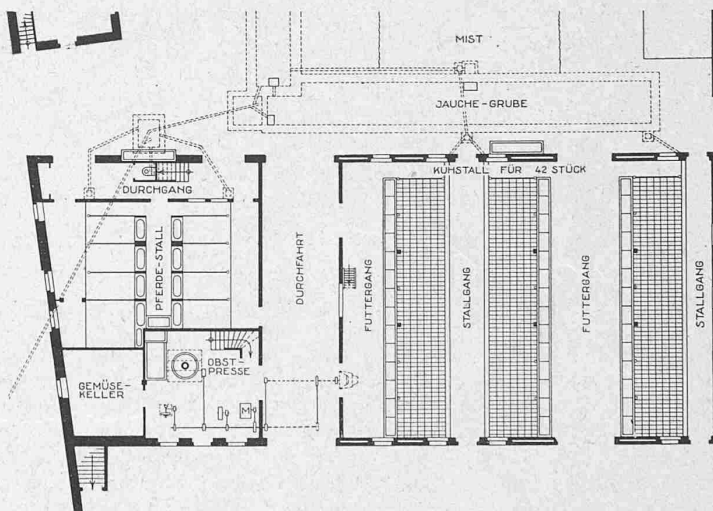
bis 5. Grundrisse und Längsschnitt. — Masstab 1:400.
